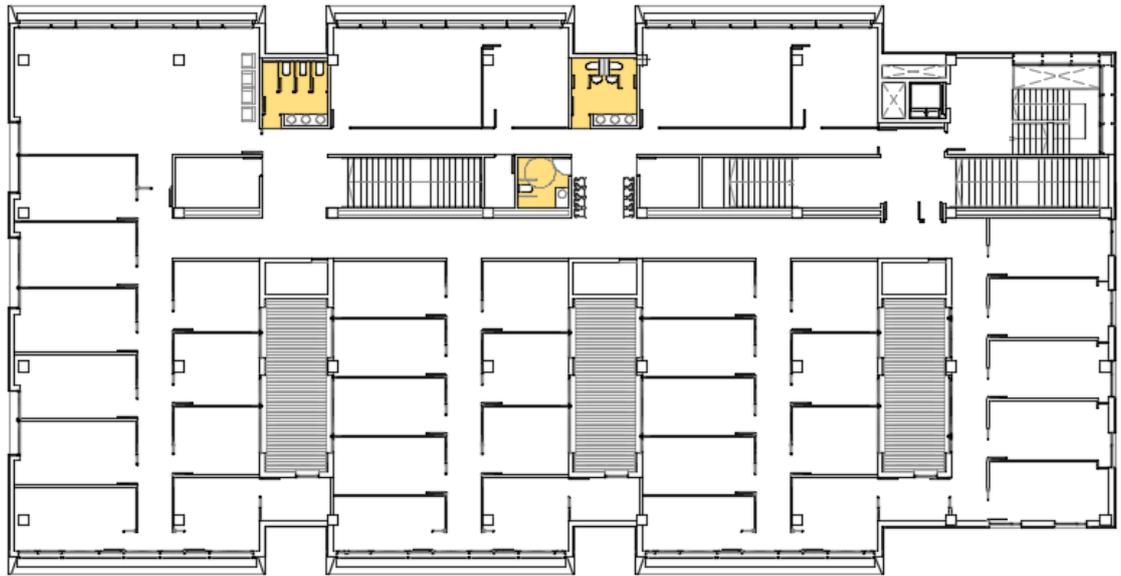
Situación Aseos en Planta Primera. Figura extraída del plano 53.
